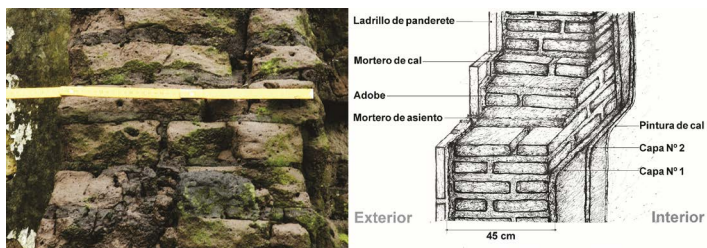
Detalle de muro de adobe de 45 cm. Izq. Fotografía. Fuente: Salas (2018). Der. Detalle de traba utilizada para los muros de adobe de 45 cm. Fuente: Piñero (2024).
